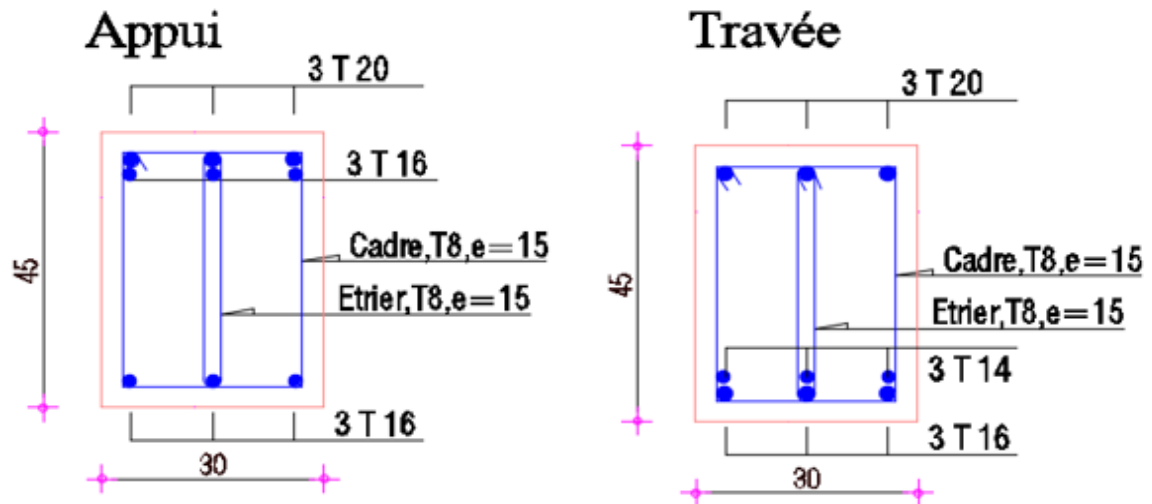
Ferrailage des poutre principale usage terrasse
